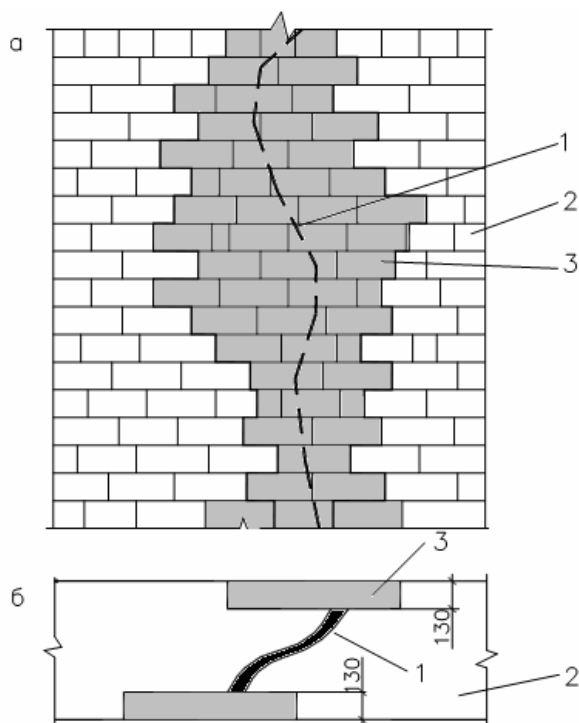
Восстановление каменной кладки частичной перекладкой:
